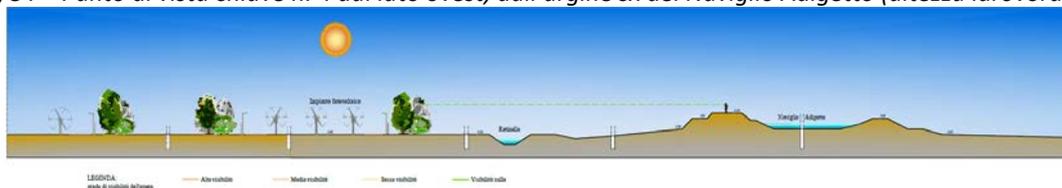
/85 – Sezione di intervisibilità dal punto di vista chiave n. 4 dal lato ovest, dall'argine dx del Naviglio Adigetto (altezza idrovora Retinella)
